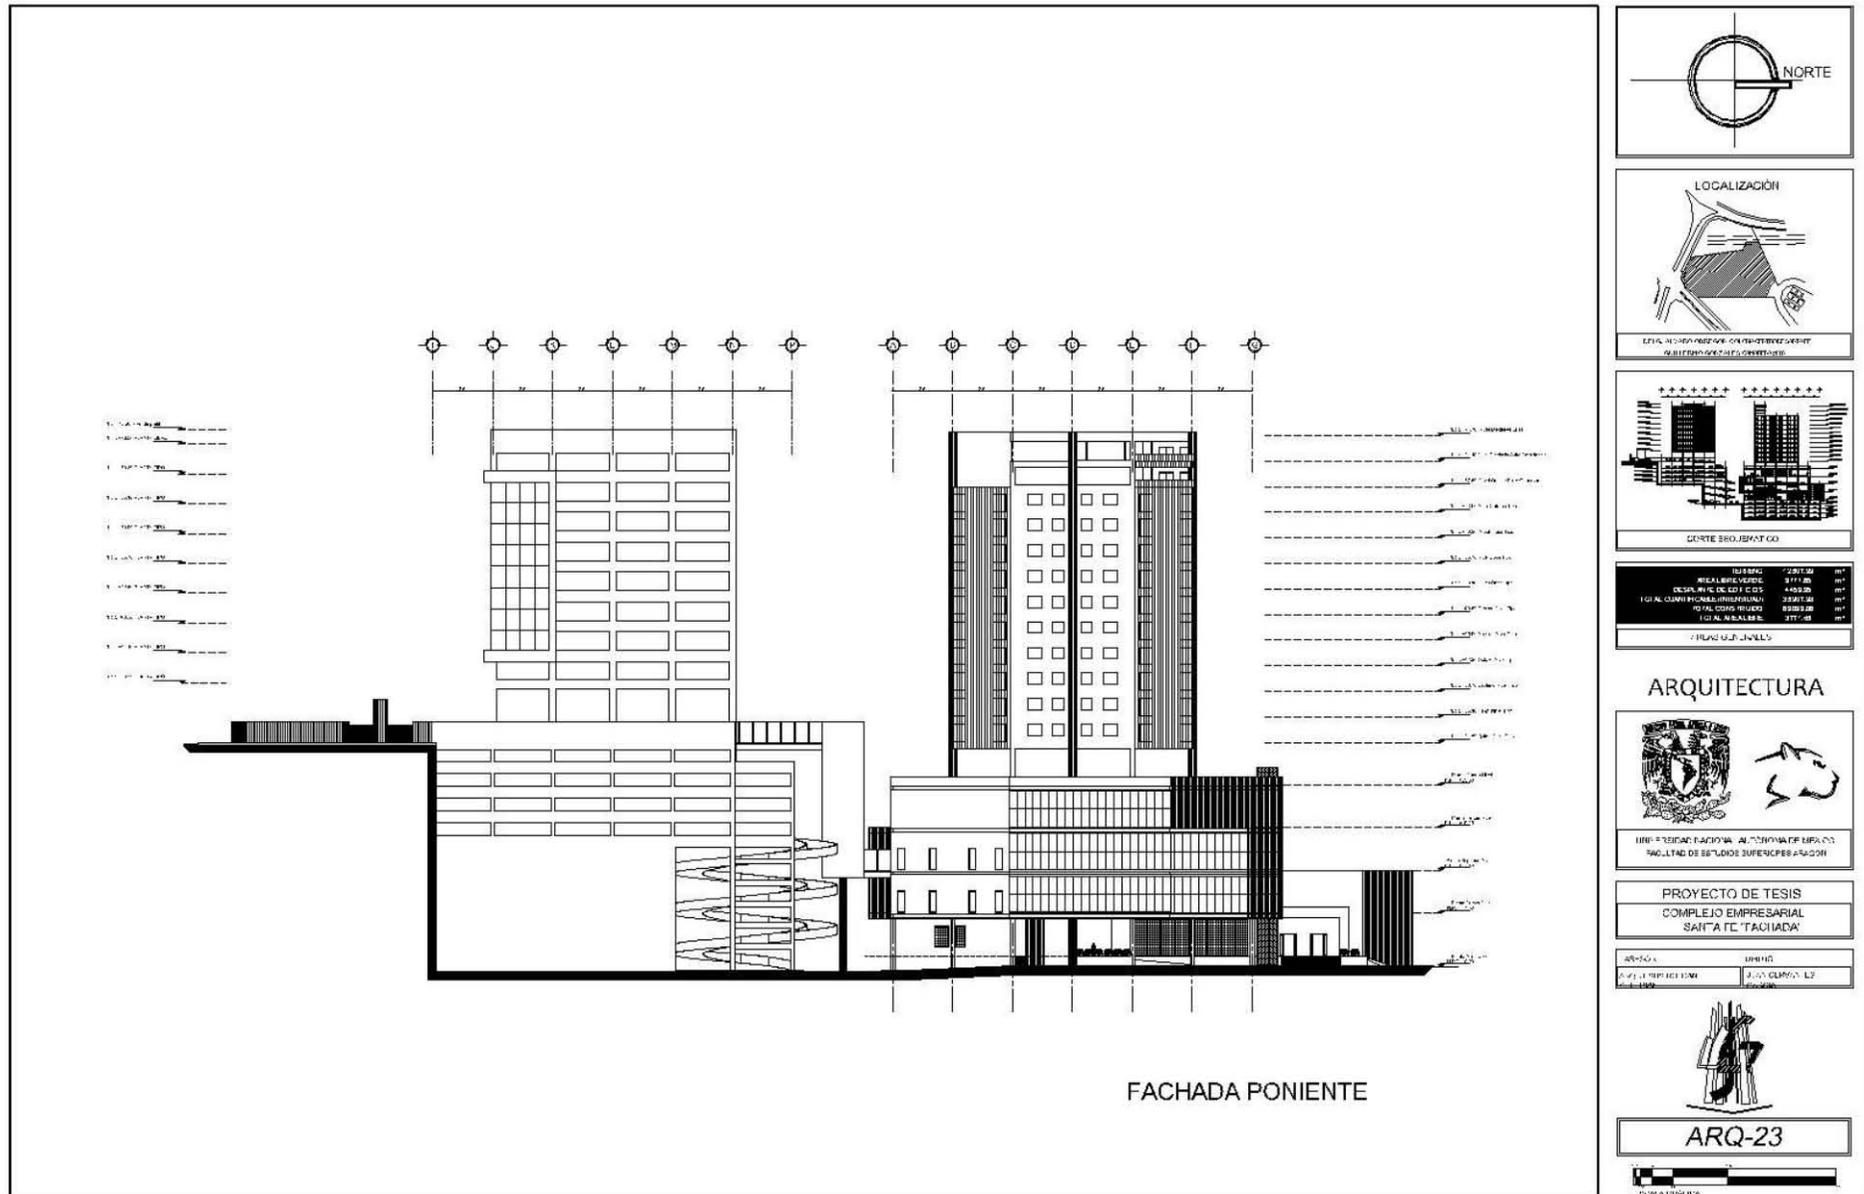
Plano ARQ-23; Fachada Poniente Oficinas, Hotel y Centro Comercial. Edición propia.
